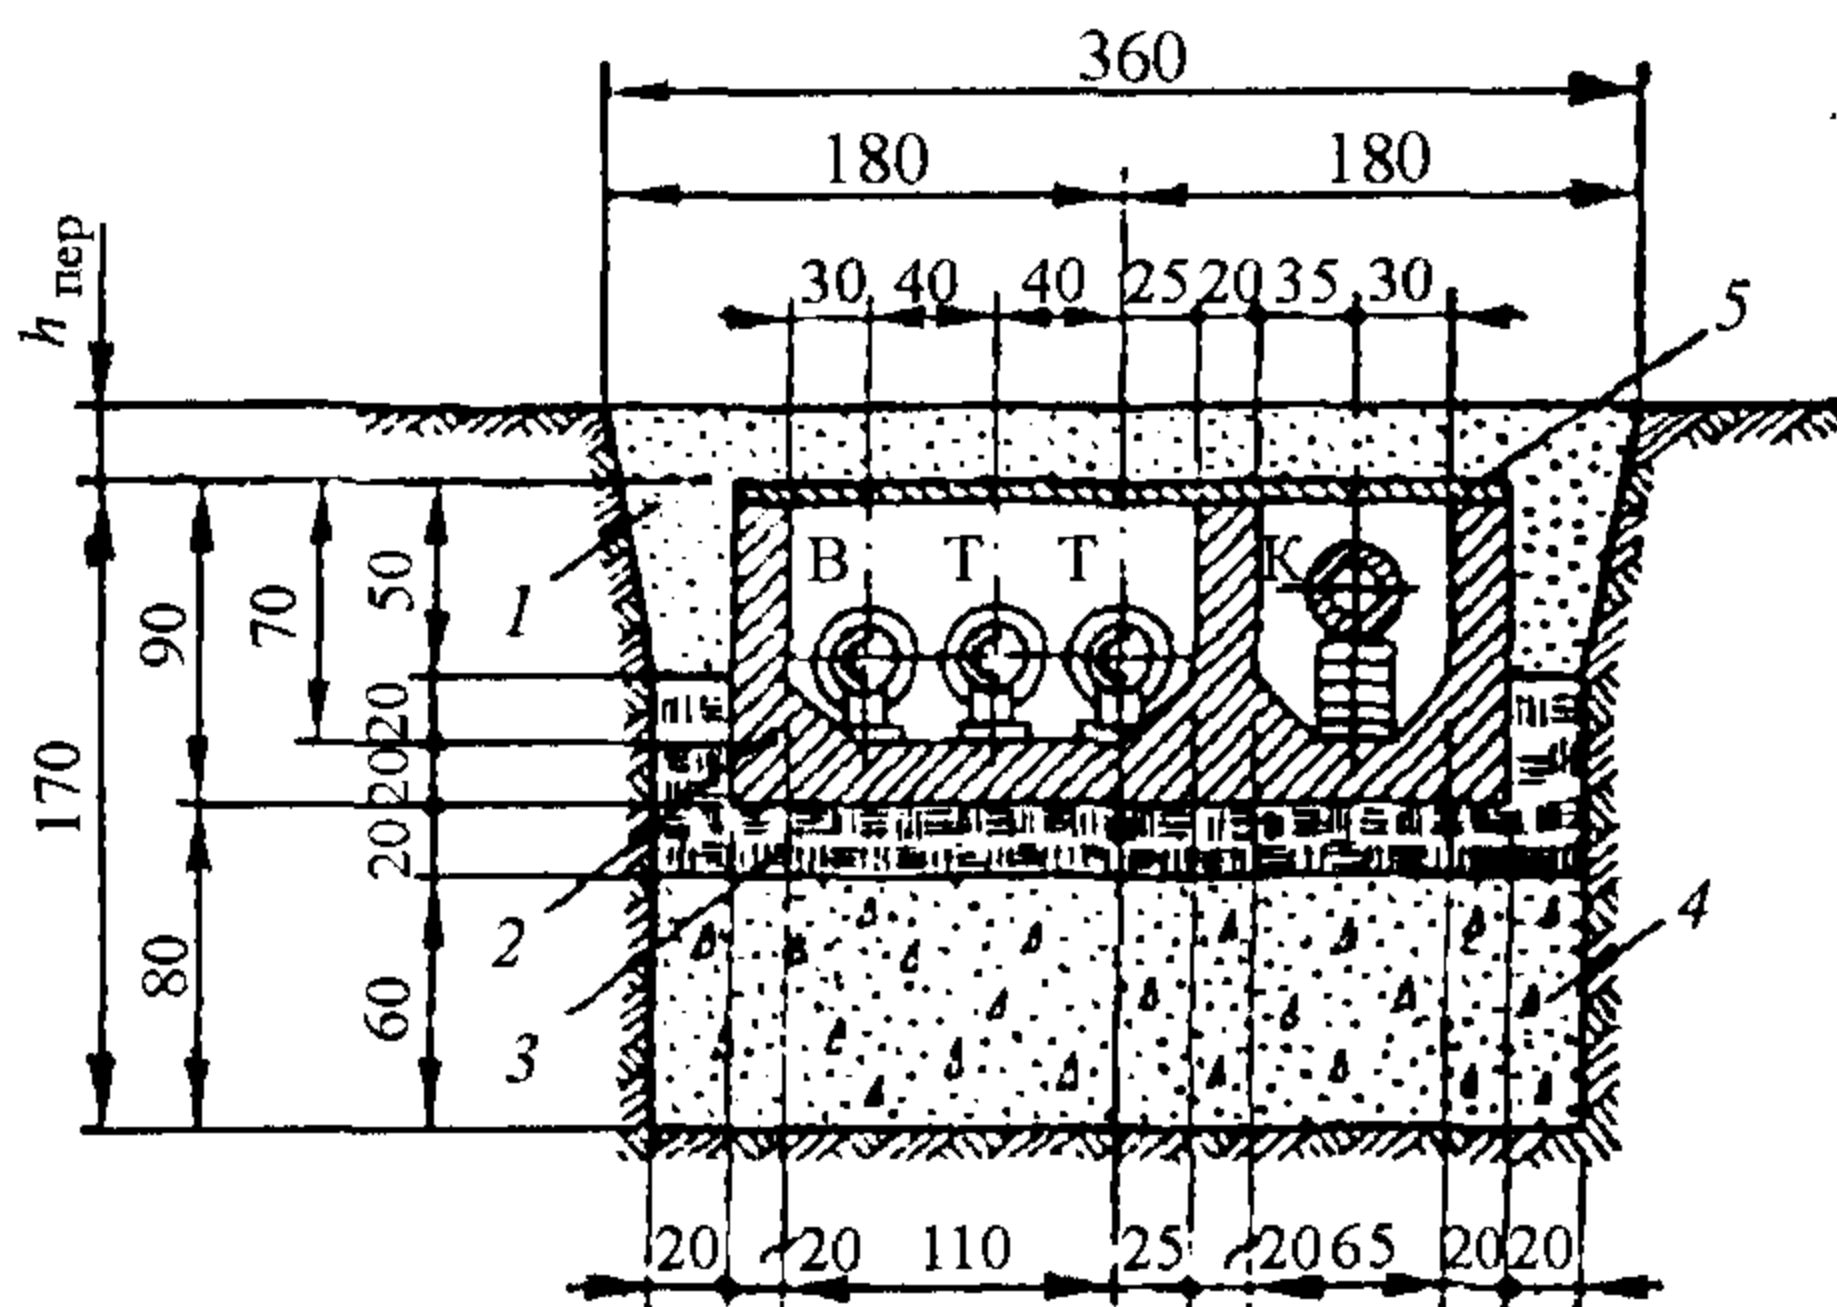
Непроходной двухсекционный железобетонный канал:
